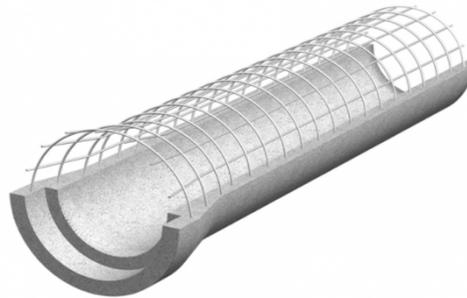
Detalle de tubería de hormigón sin camisa de chapa
